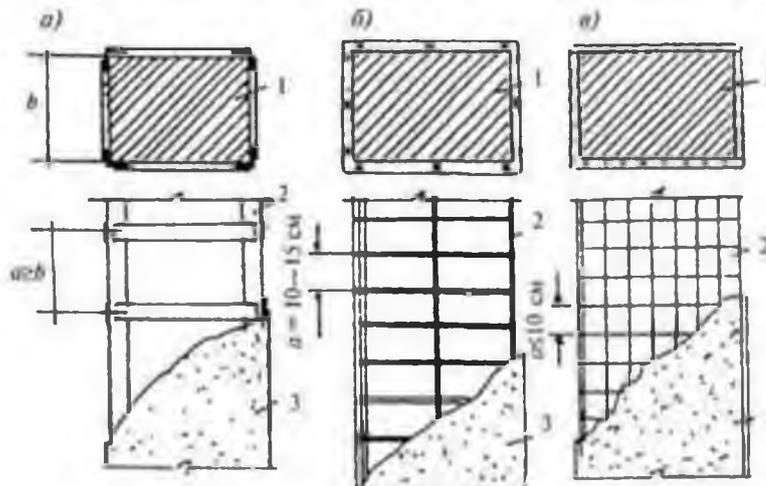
Посилення стовпів сталевий обоймою (а), армокаркасів (б), сітками і залізобетонними обоймами (в, г): 1 – конструкція підсилення; 2 –
